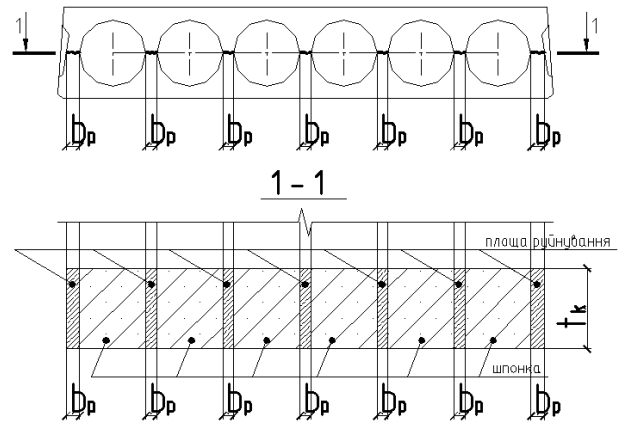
Схема до розрахунку міцності верхньої полиці плити на відрив, враховуючи тільки роботу бетону на розрив стінок плити / The scheme to calculate the strength of plates on the top shelf break, whereas only work to break concrete slab walls
